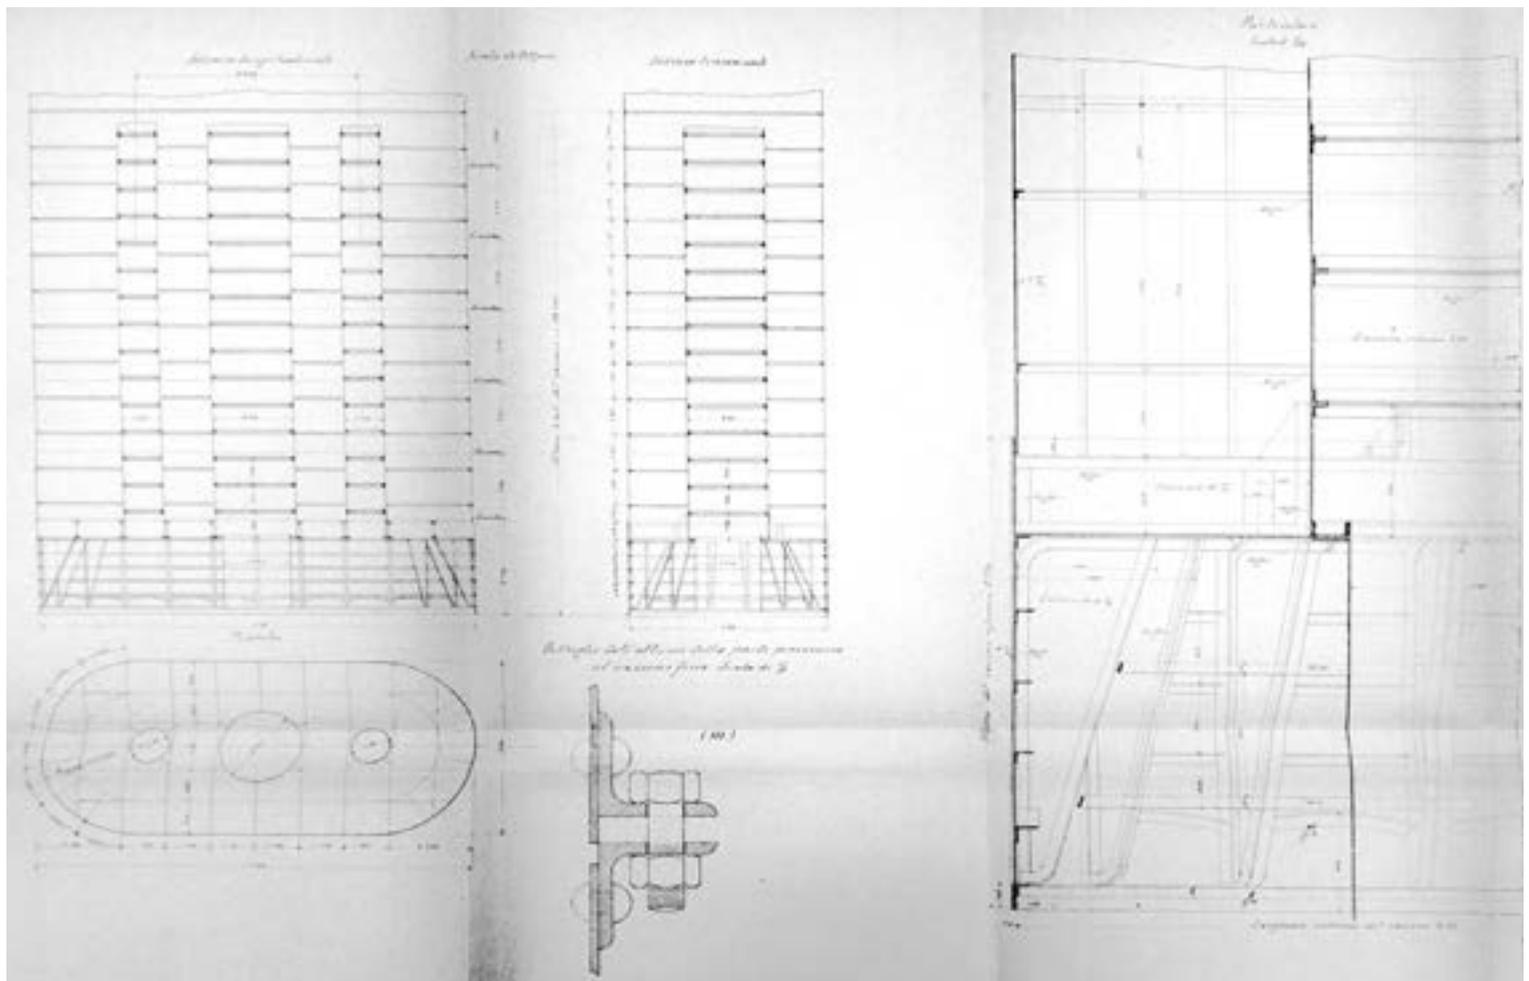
| Ponte a Piacenza: dettagli costruttivi della struttura in ferro del cassone (Biadego, 1886).
